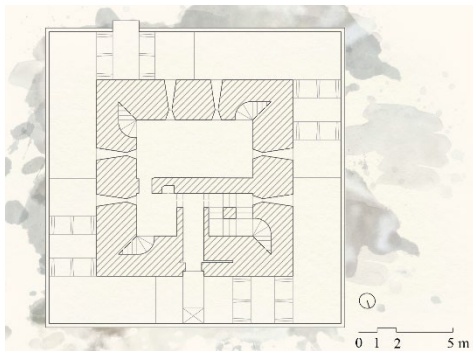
Isola di Santo Stefano, Arcipelago di La Maddalena, pianta del piano terra della Torreforte (elaborazione grafica di Elisa Alberta Bianchi, 2024).
